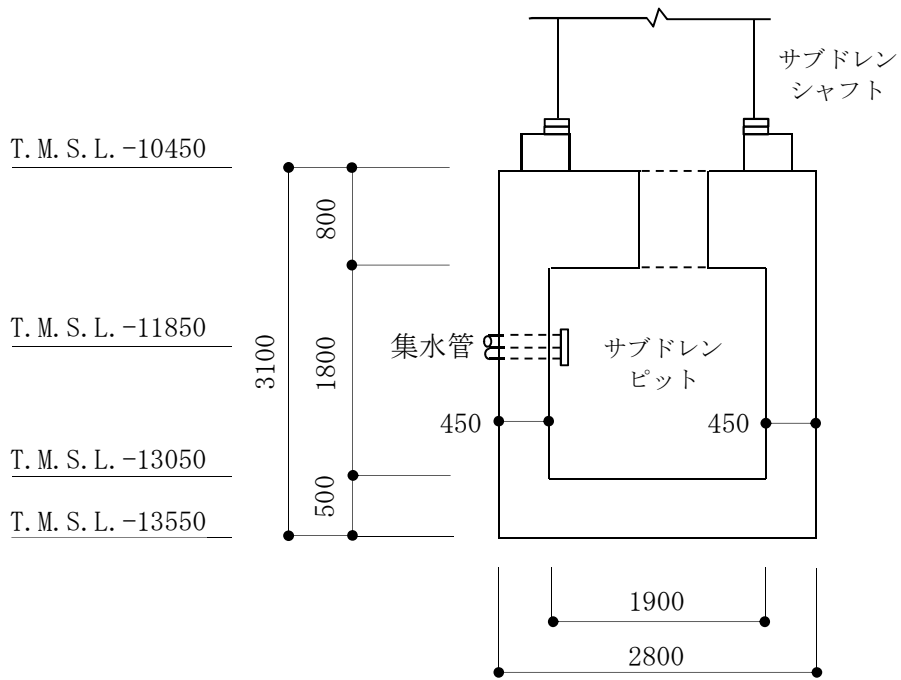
タービン建屋サブドレンピットの概略断面図 (B-B 断面) (単位 : mm)
